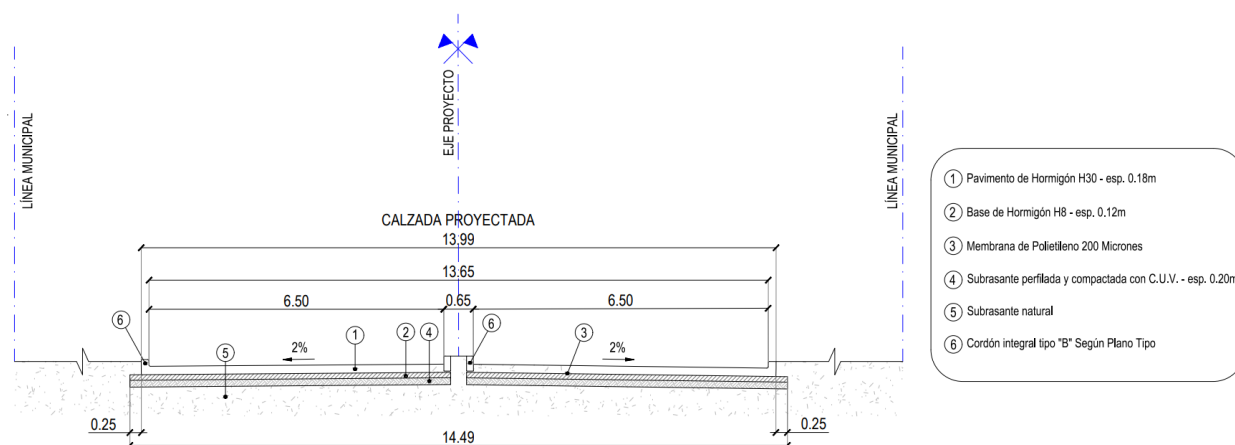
Paquete estructural proyectado para la Calle 143. Fuente: Municipalidad de Berisso.
